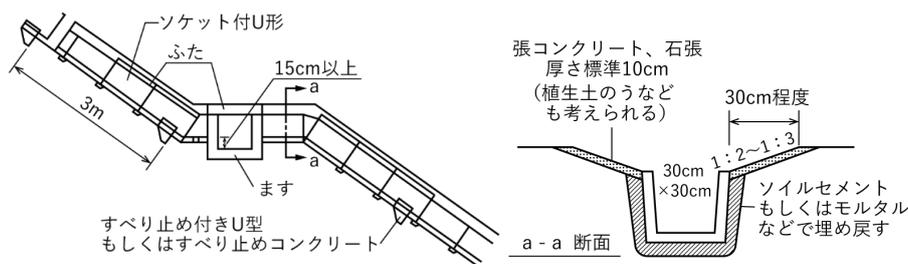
鉄筋コンクリートU字溝による縦排水工の例
